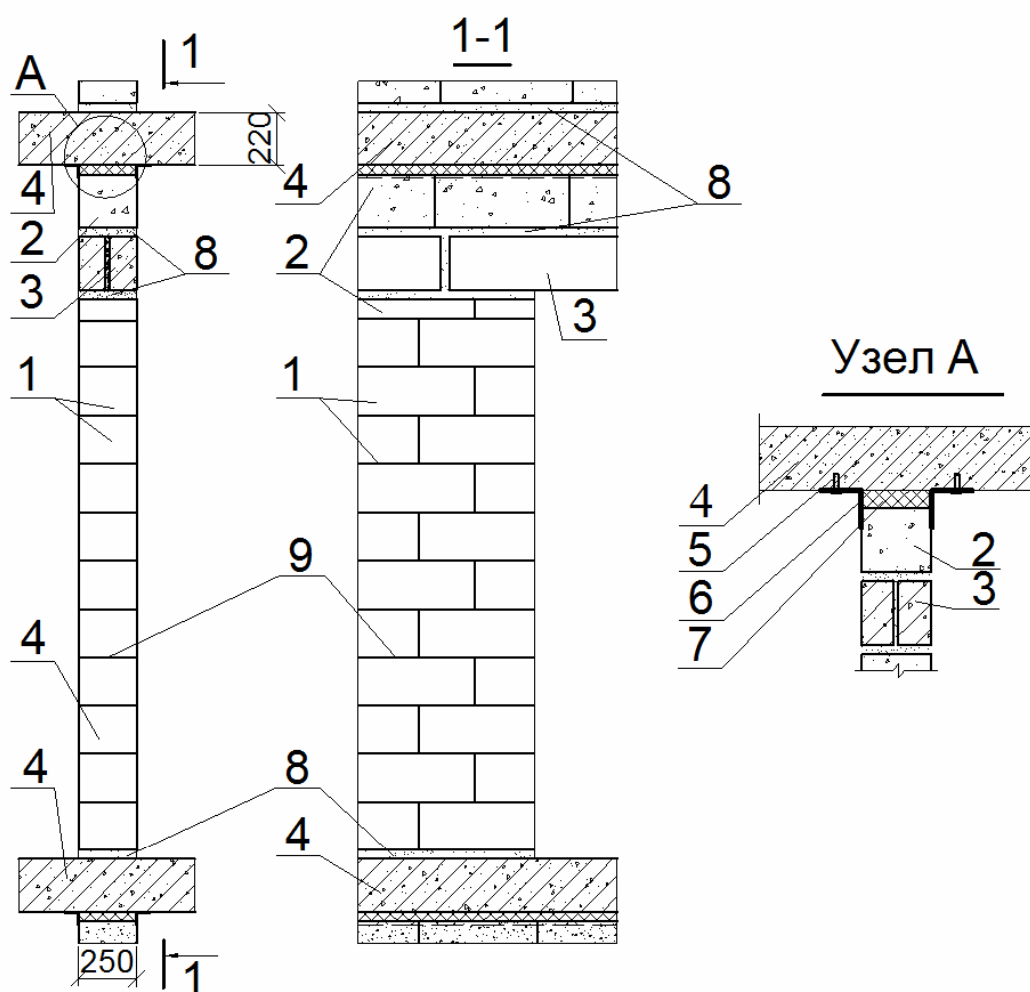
Монтаж межблоксекционной внутренней несущей стены из газобетонных камней на клею с минераловатным вкладышем в зоне примыкания перегородки из газобетонных блоков
